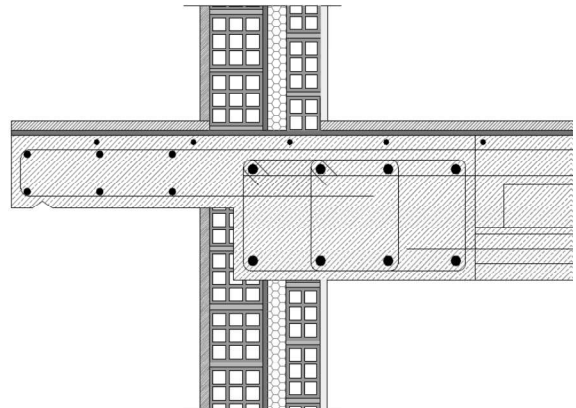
Fachada-Forjado (balcón). Zona este. Estado rehabilitado.
